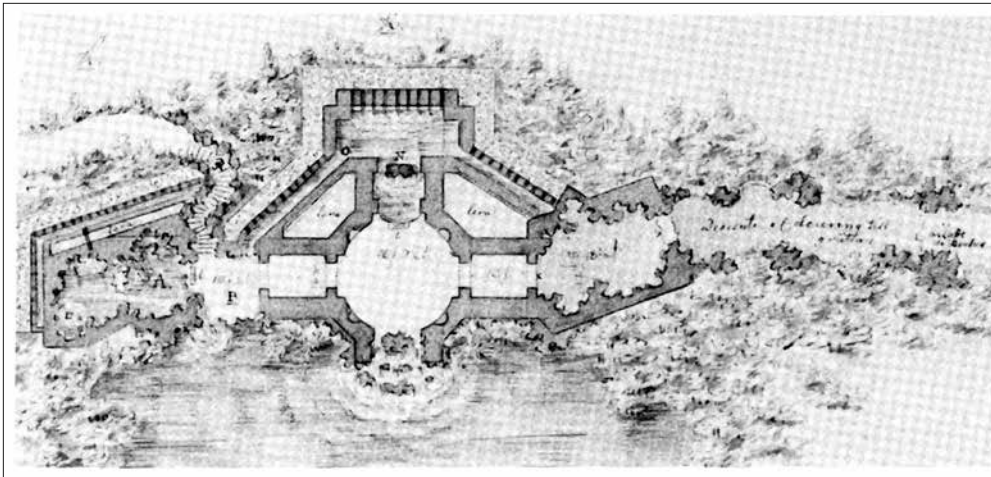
Grundriss der Grotte von Stourhead, Zeichnung von Frederik Magnus Piper um 1775 (aus: Naomi Miller, *Heavenly Caves*, Boston 1982)
